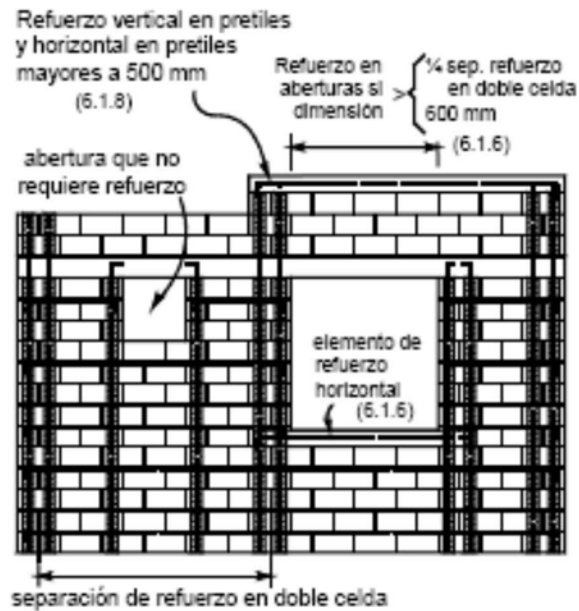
b) Refuerzo en aberturas y perfiles.
